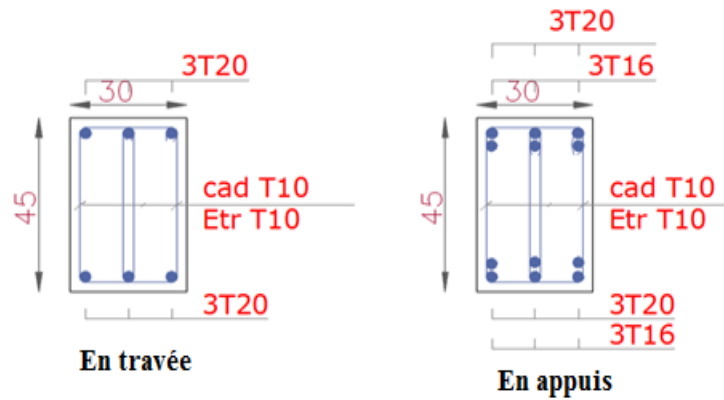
Schéma de ferrailage de poutre secondaire (zone 3)
